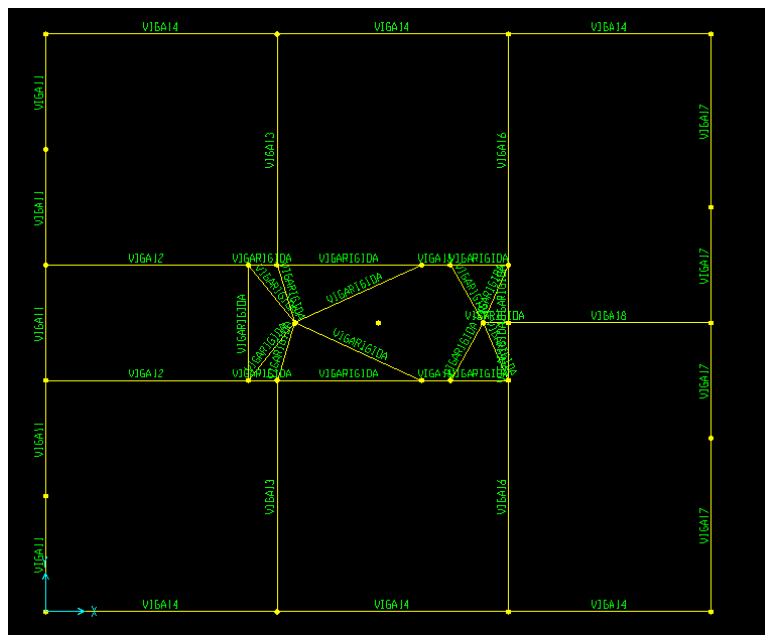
Ligação do núcleo aos elementos adjacentes com vigas rígidas.
